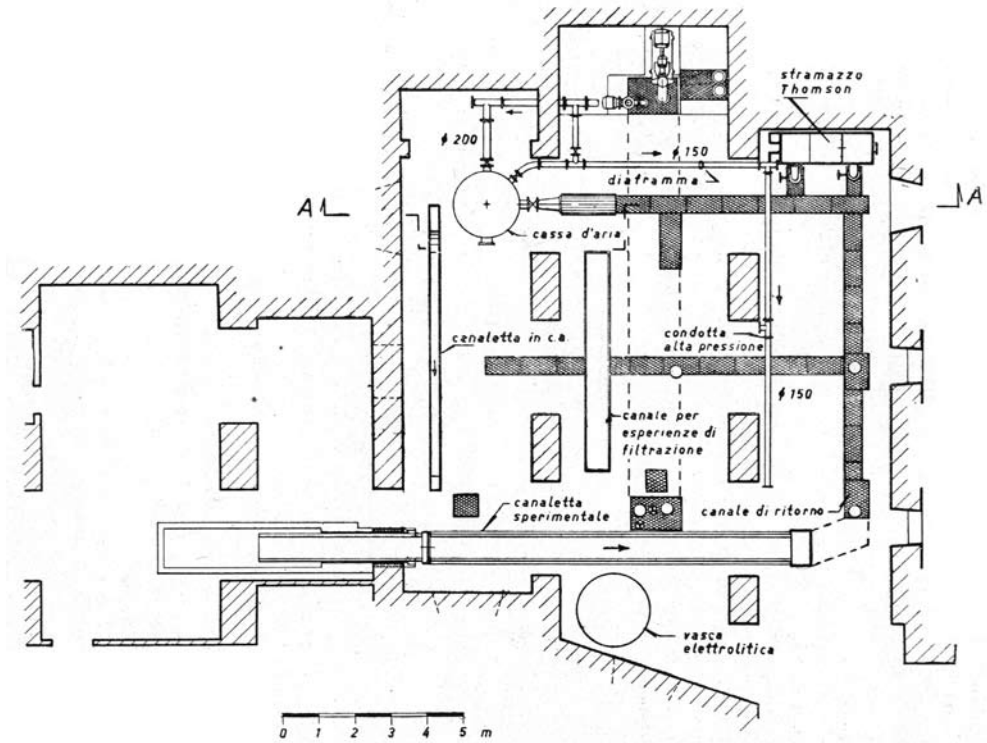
Pianta del Laboratorio di Idraulica agraria (1963).
